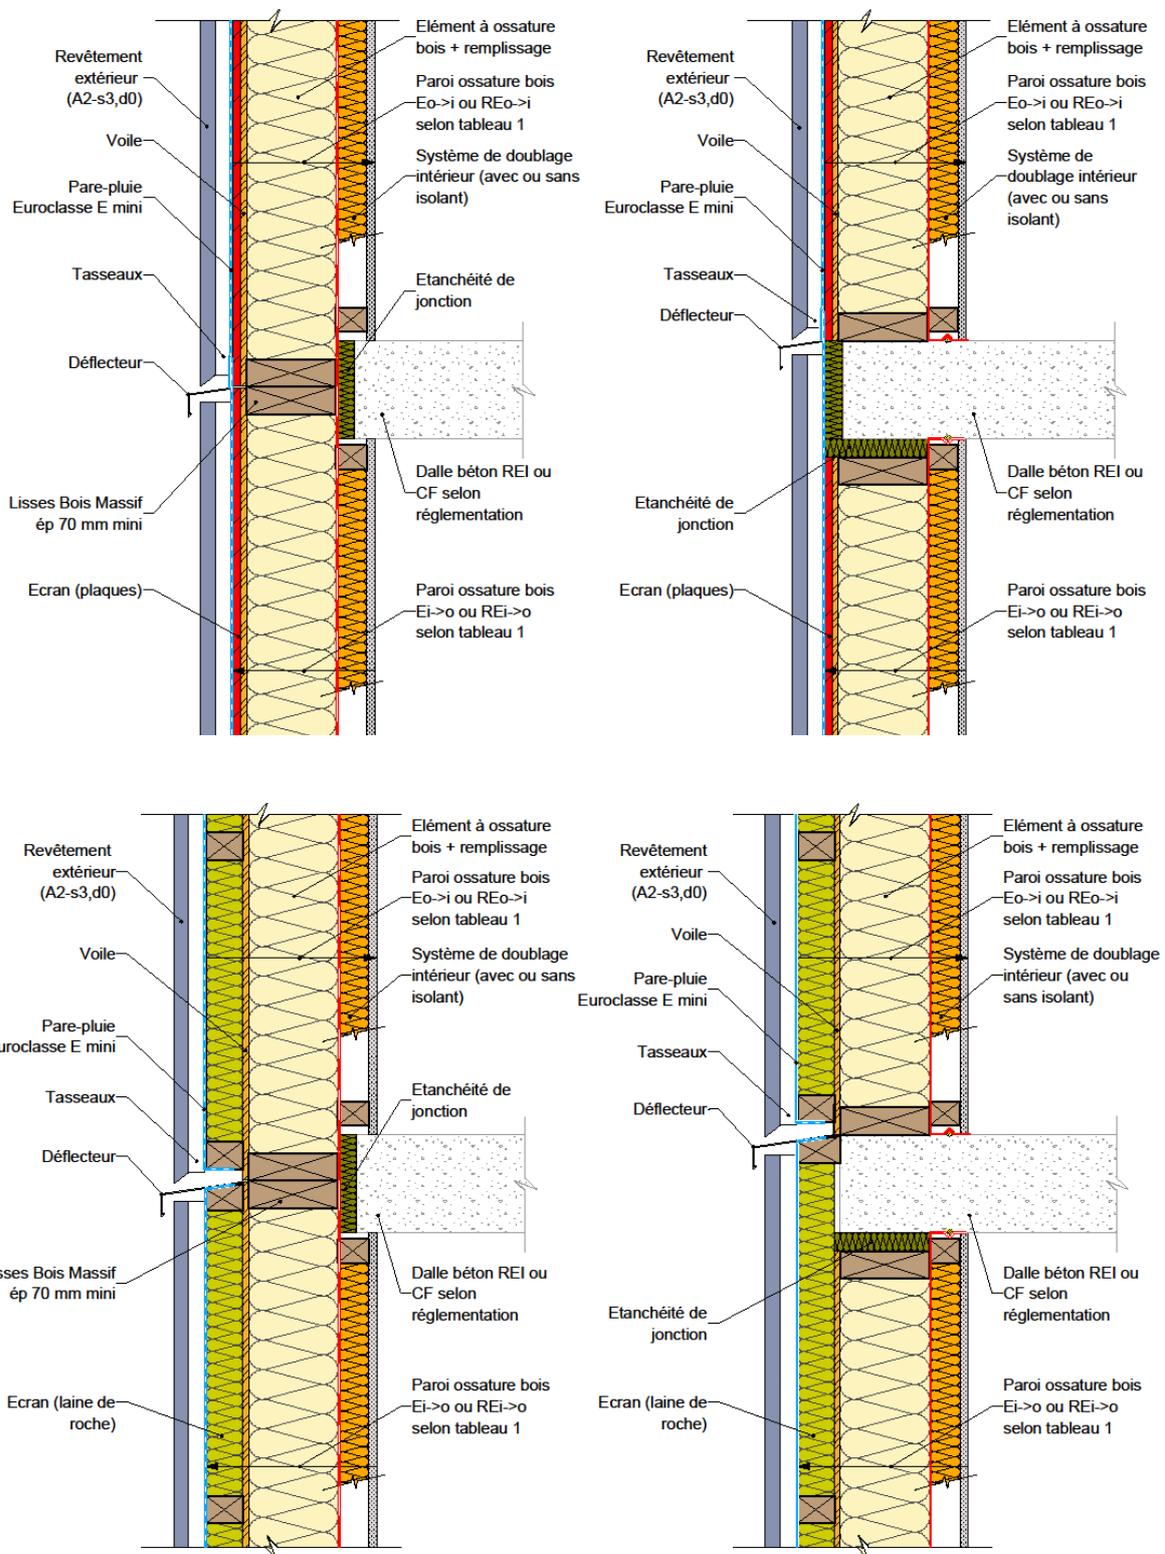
Façade/mur en ossature bois & plancher en béton.
